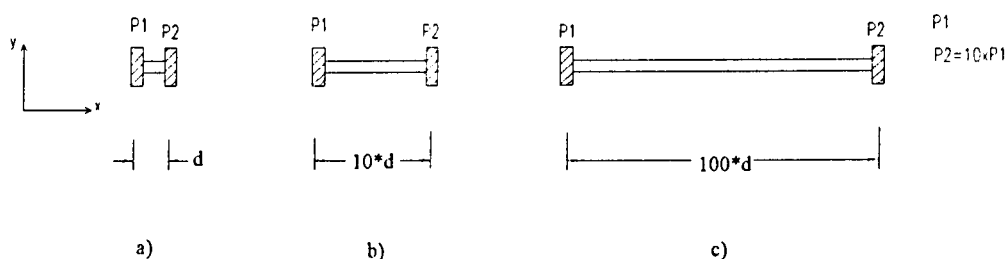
Estrutura constituída por dois pilares P1 e P2 - Três posições relativas em planta.
